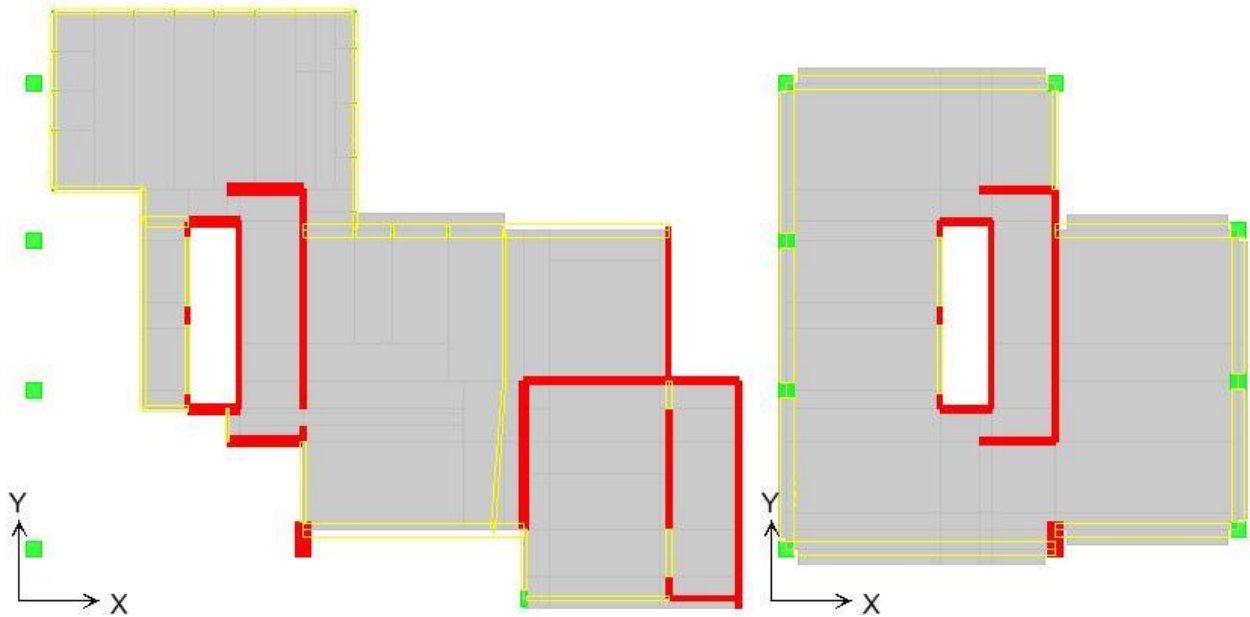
Planta primer piso (izquierda) y piso tipo (derecha) edificio O2
